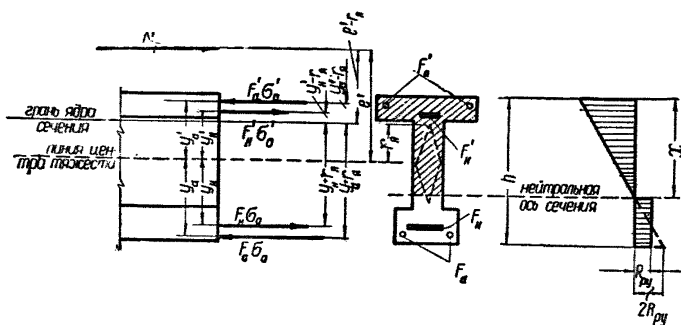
Схема распределения напряжений и усилий предварительно напряженного железобетонного внецентренно сжатого элемента при расчете трещиностойкости зоны, содержащей арматуру F_n и F_a
